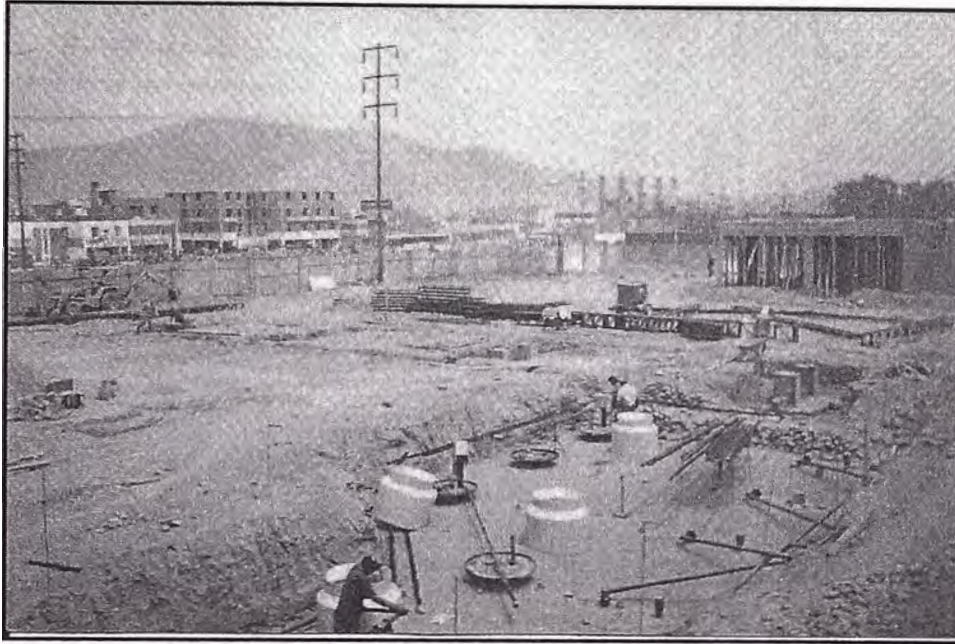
Vista panorámica de la zona, los tanques y bombas sumergibles están colocados en su posición, el tendido de tuberías de acero, las zapatas lista para recibir la estructura metálica
